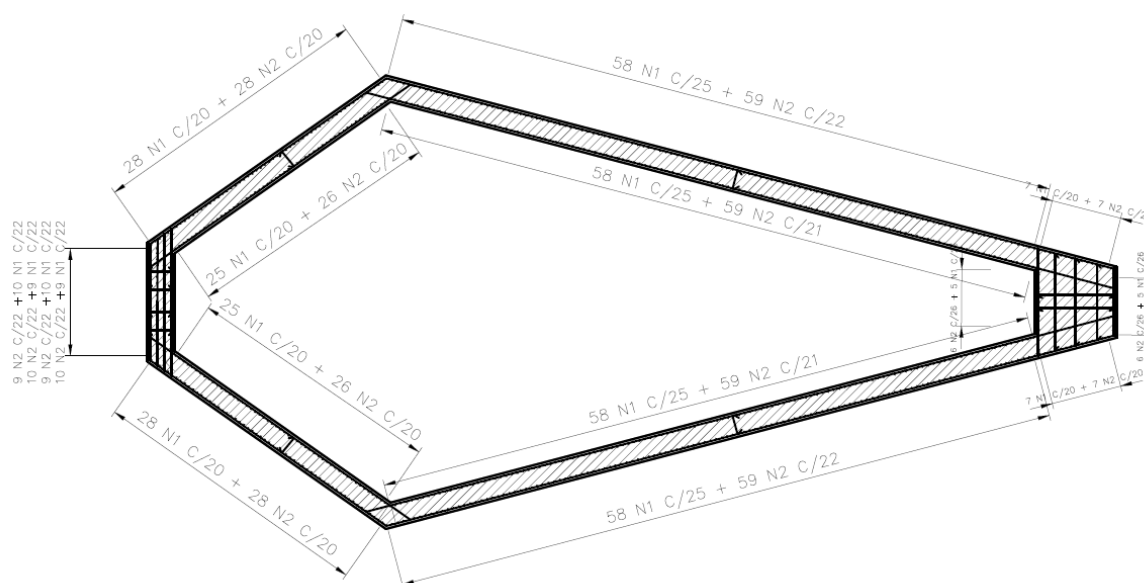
Projeto de detalhamento de armaduras longitudinais das paredes do pilone da Ponte do Saber (adaptado de VGARAMBONE, 2012).
